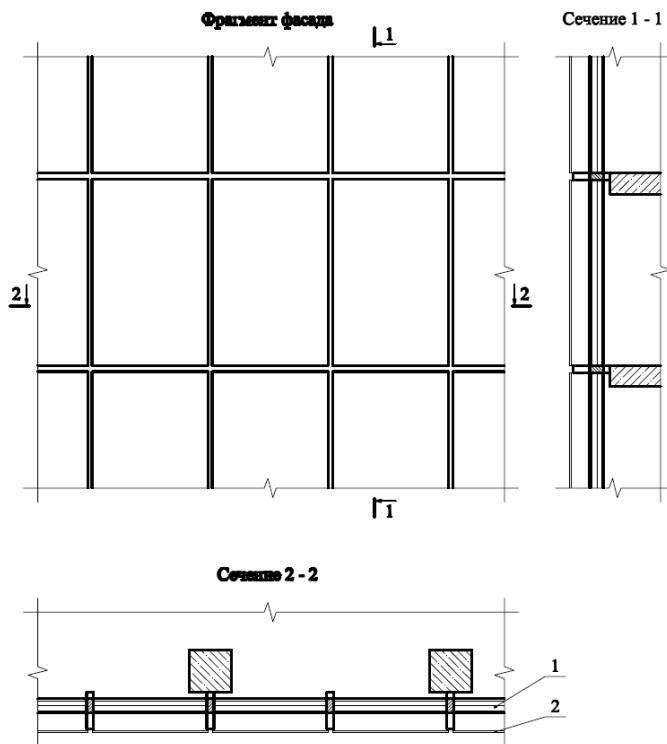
Фасад с устройством дополнительного наружного остекления («двойной фасад»): 1 – основной внутренний слой остекления, 2 – дополнительный наружный слой остекления
